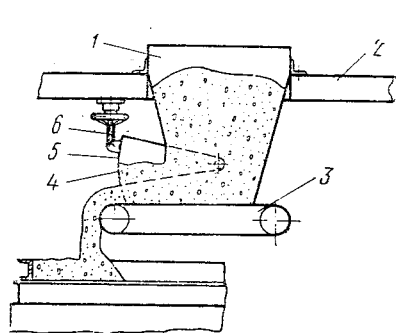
Схема работы бетоноукладчика с ленточным питателем:
